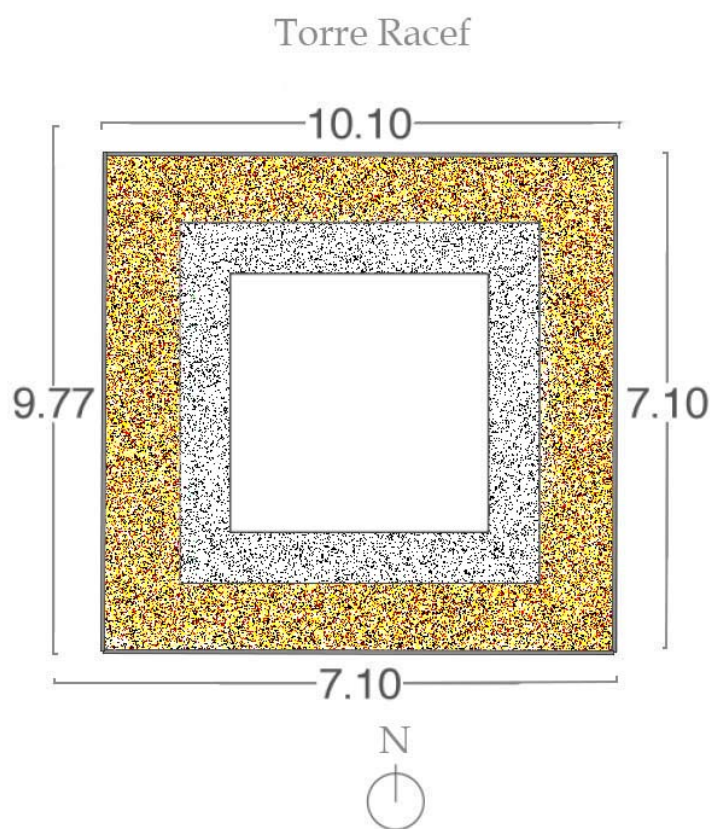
Planta de la torre Racef de Almussafes. Elaboración propia.
